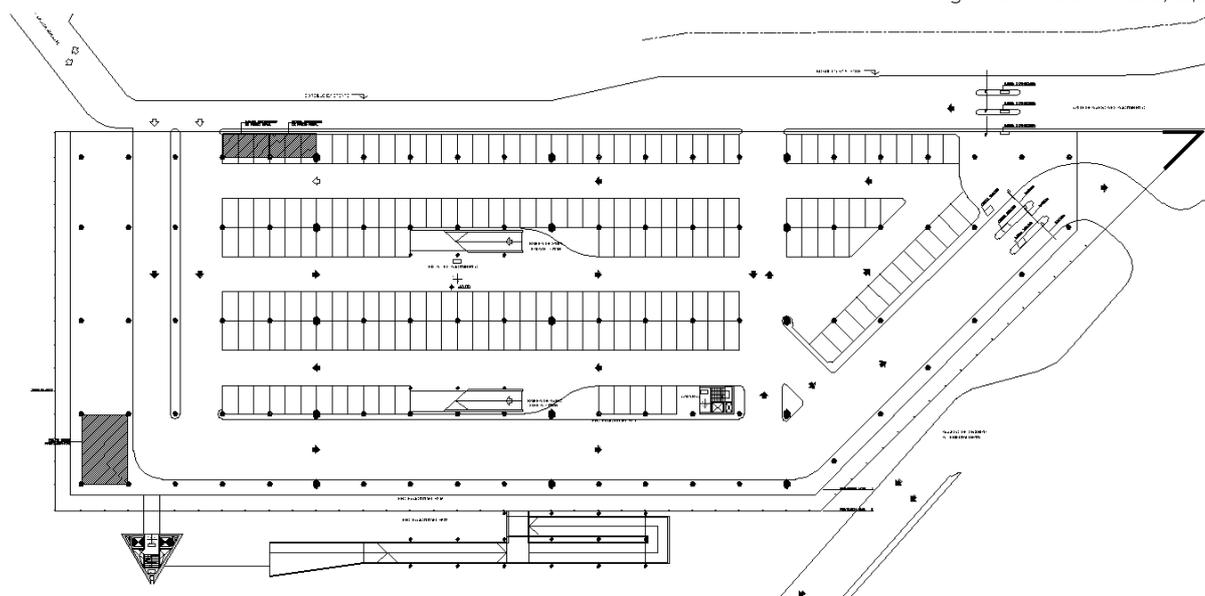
Planta baja del edificio de parqueos. Se aprecia la retícula estructural
